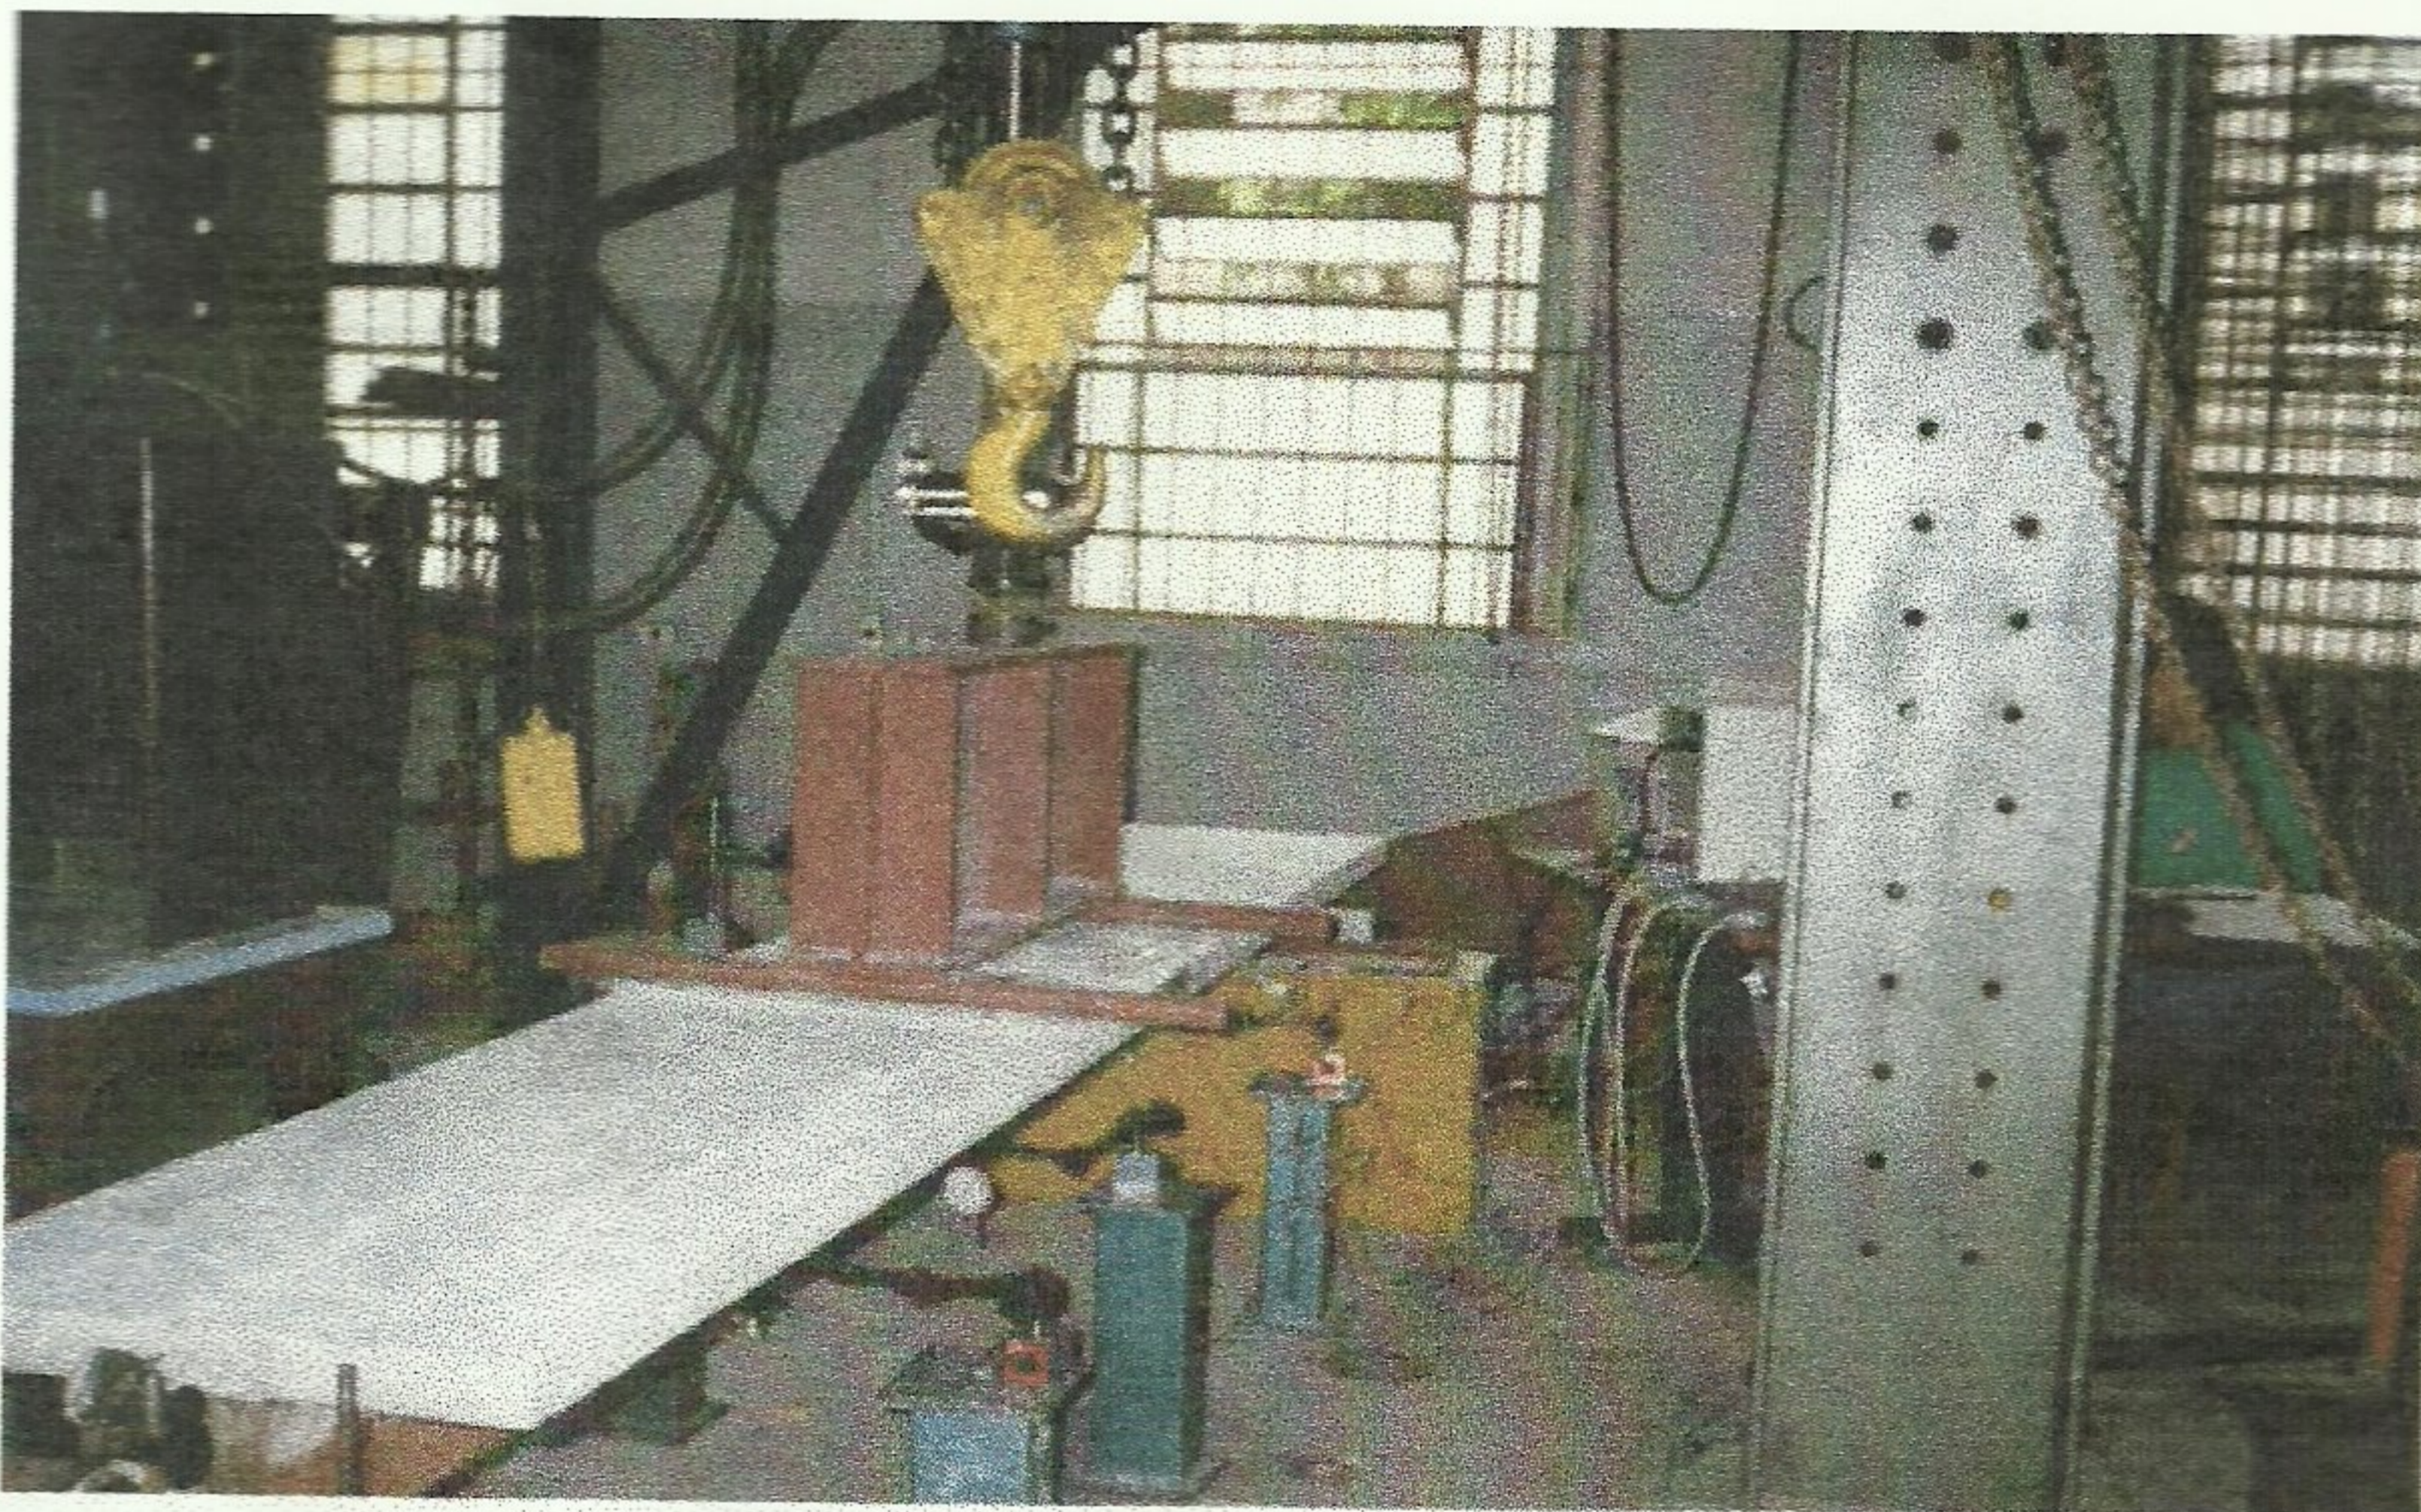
Vista do Ensaio de flexão da Viga Composta Madeira/Concreto
